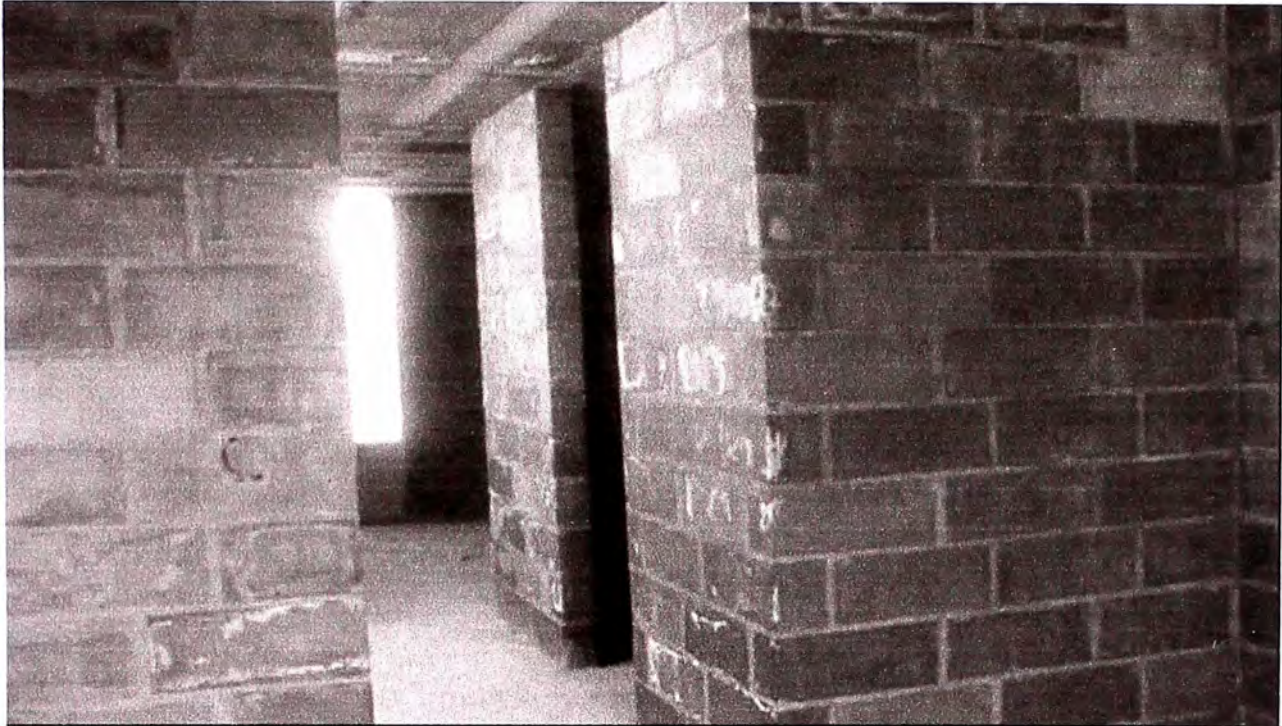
Proyecto Piloto Martinete – Sistema de Albañilería Armada
